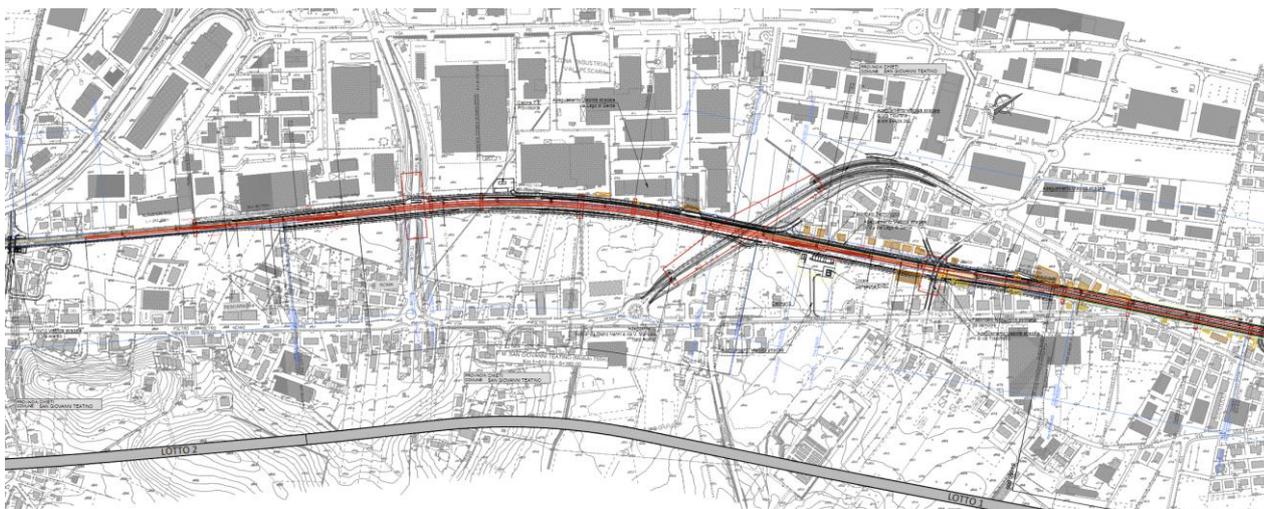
Planimetria raddoppio da pk 4+650 a pk 6+869
